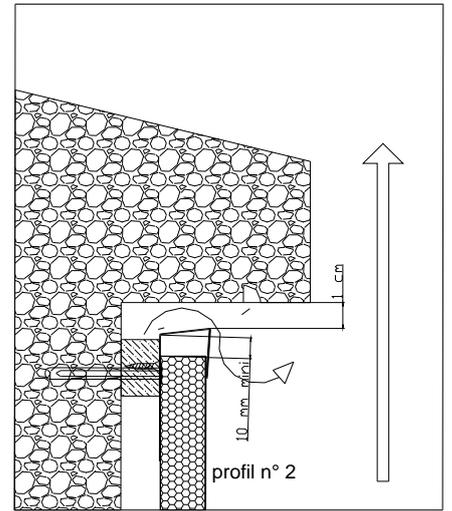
Arrêt haut de vêtage sous becquet saillant ou passée de toiture
